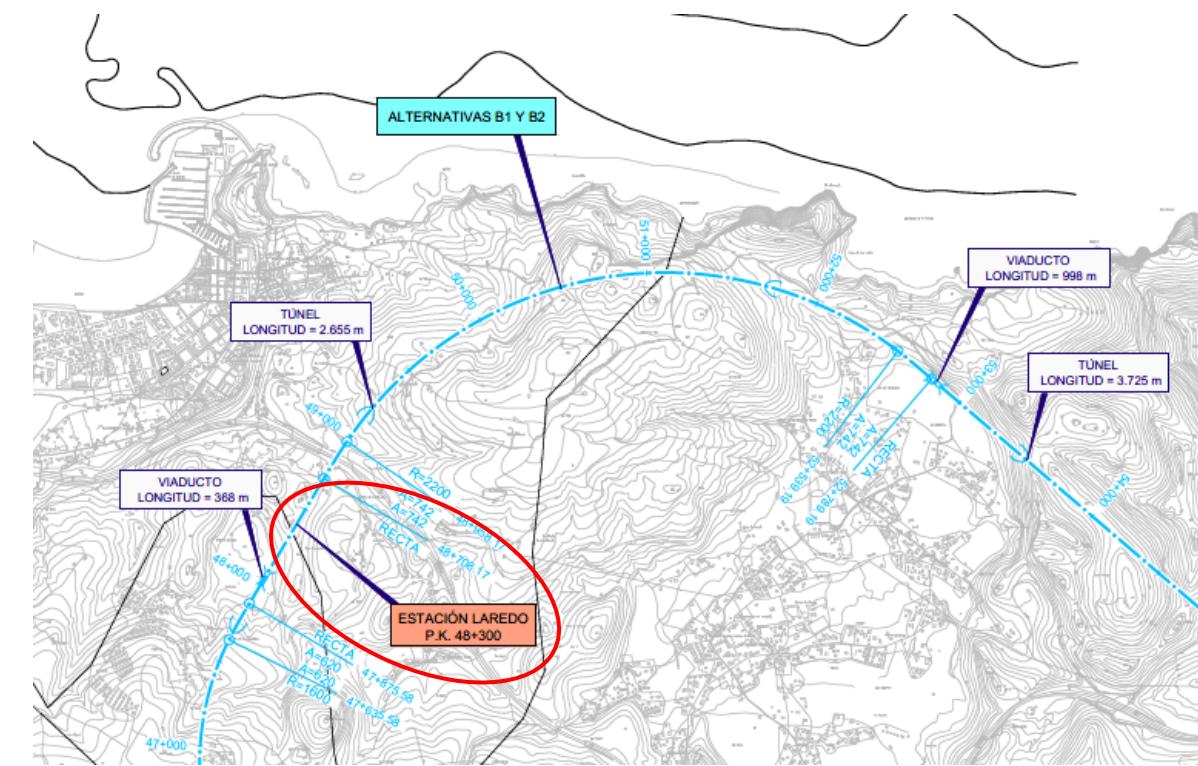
Estación Laredo en planta de Alternativa B1 y B2
